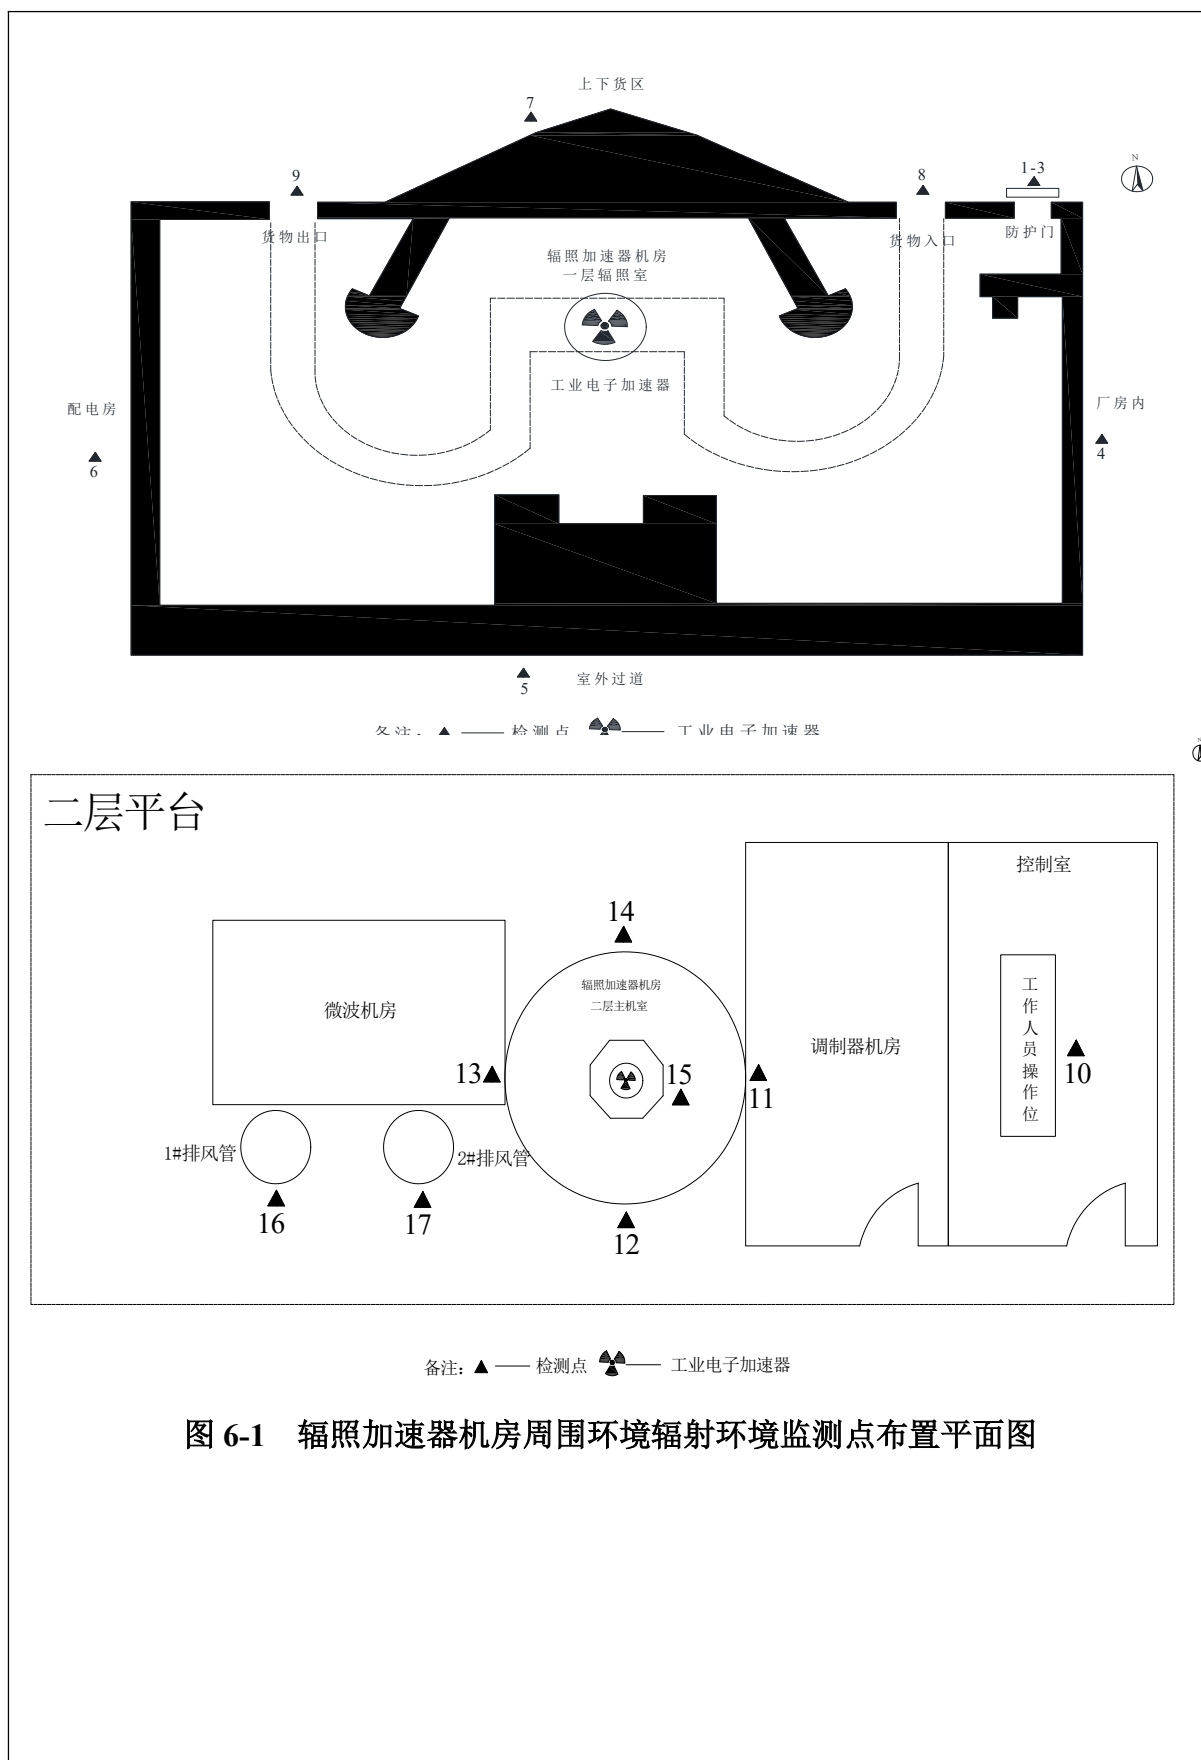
辐照加速器机房周围环境辐射环境监测点布置平面图
